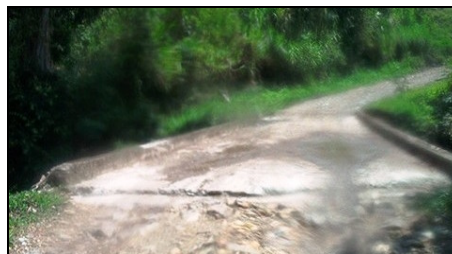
Detalle puente - superestructura. Puente La Chimera.
